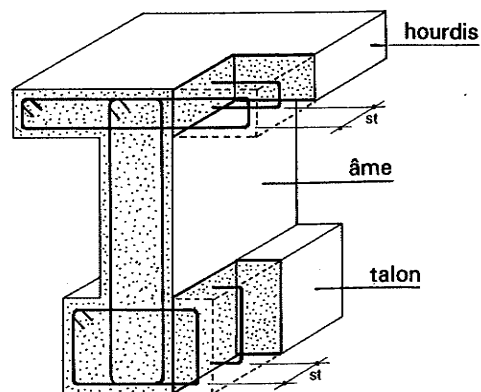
Armature transversale d'une poutre avec hourdis et talon.
